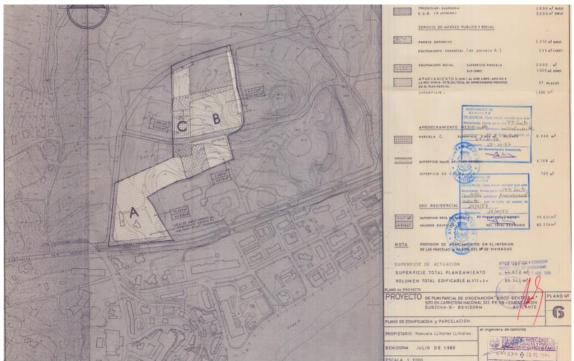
Plano ordenación pormenorizada propuesta en Plan Parcial Sinto Sentella
